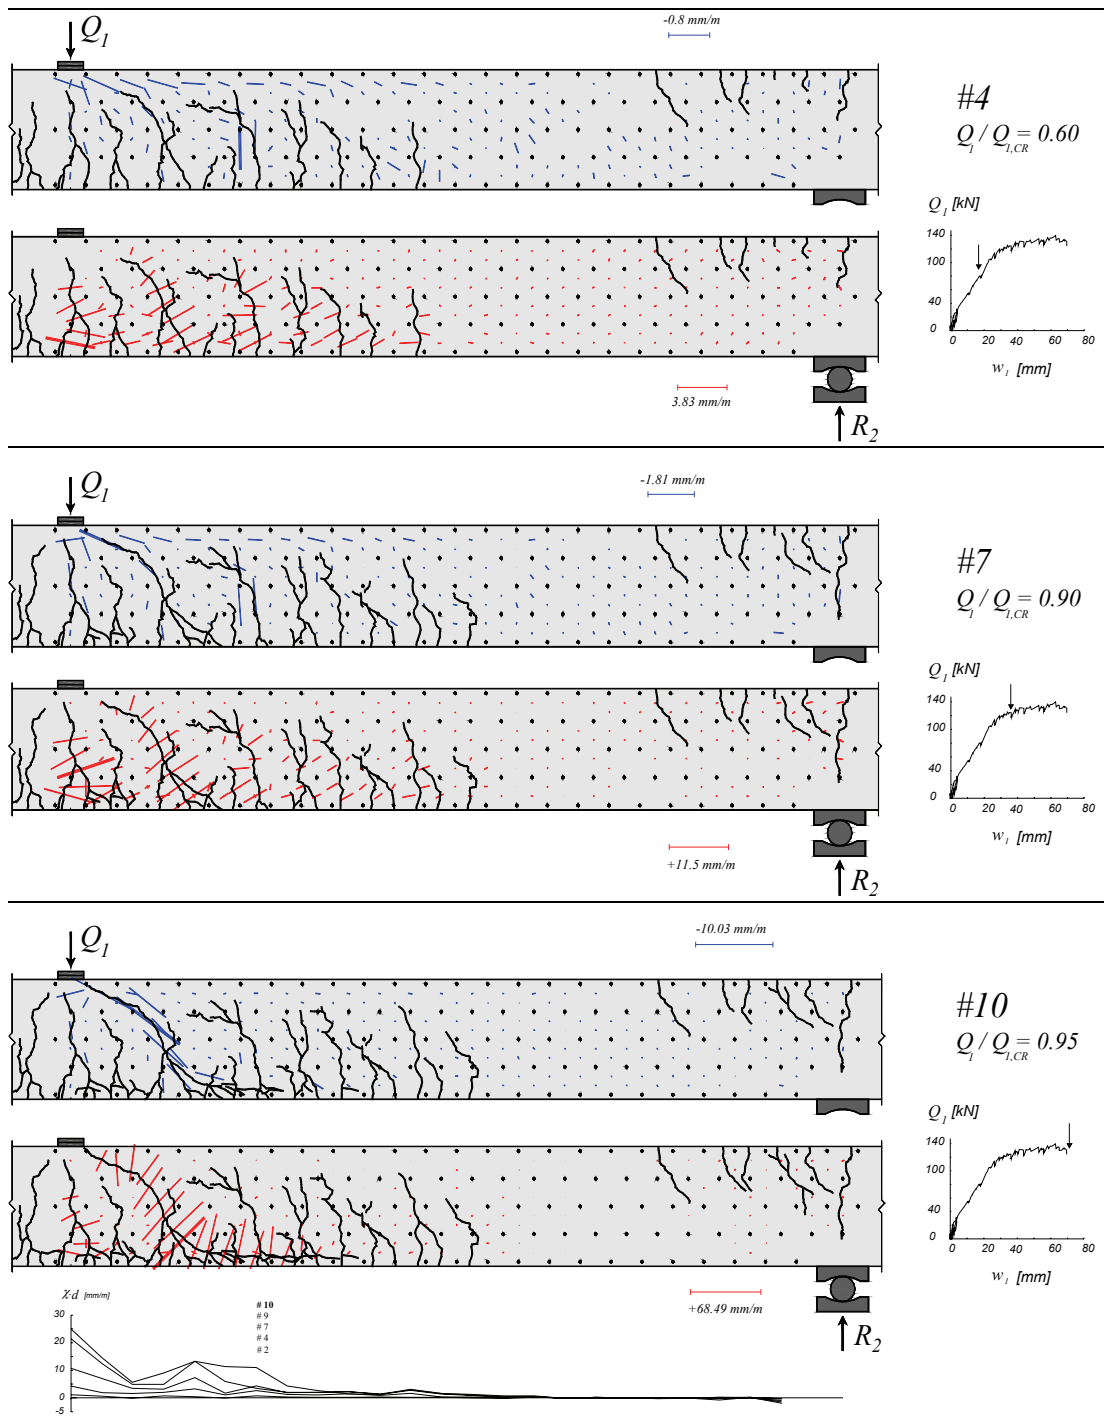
Poutre SR3: déformations principales, fissuration et courbures
